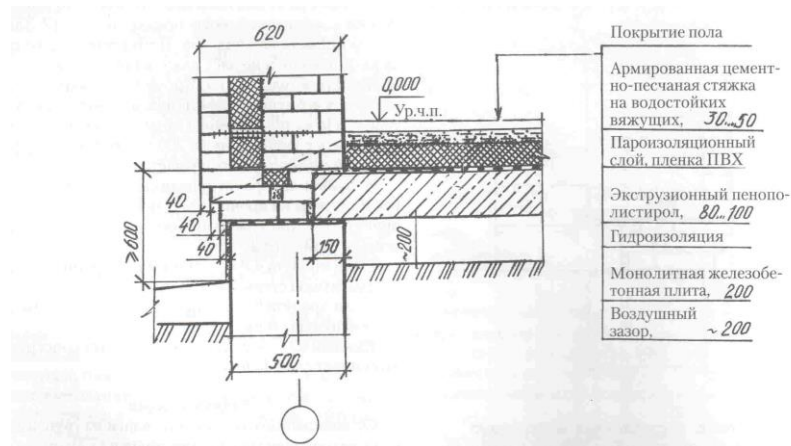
Конструкция пола по монолитной железобетонной плите
